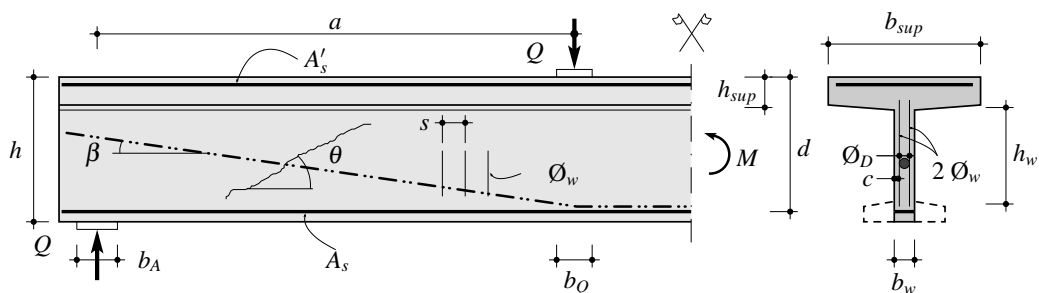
Typischer Aufbau von Versuchen an Balken mit Schubbewehrung
